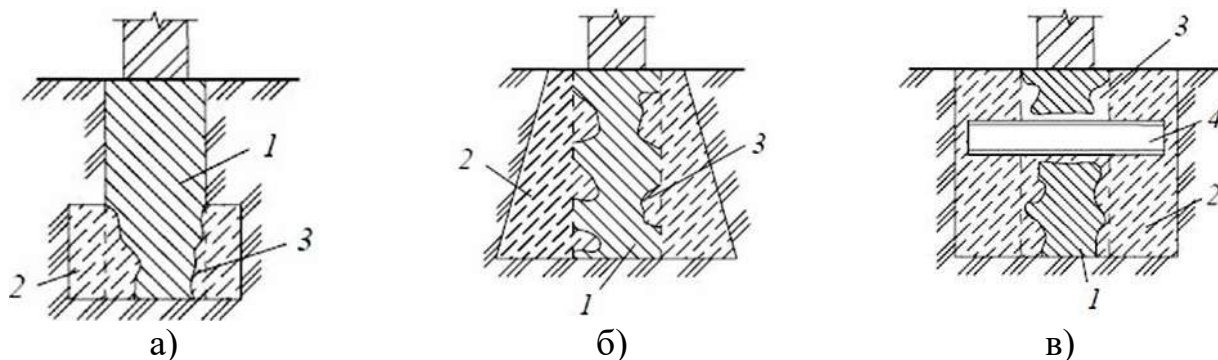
Схемы усиления ленточных фундаментов бетонными обоями: а) обойма у подошвы; б), в) трапециевидальная и прямоугольная обоймы на всю высоту тела фундамента
